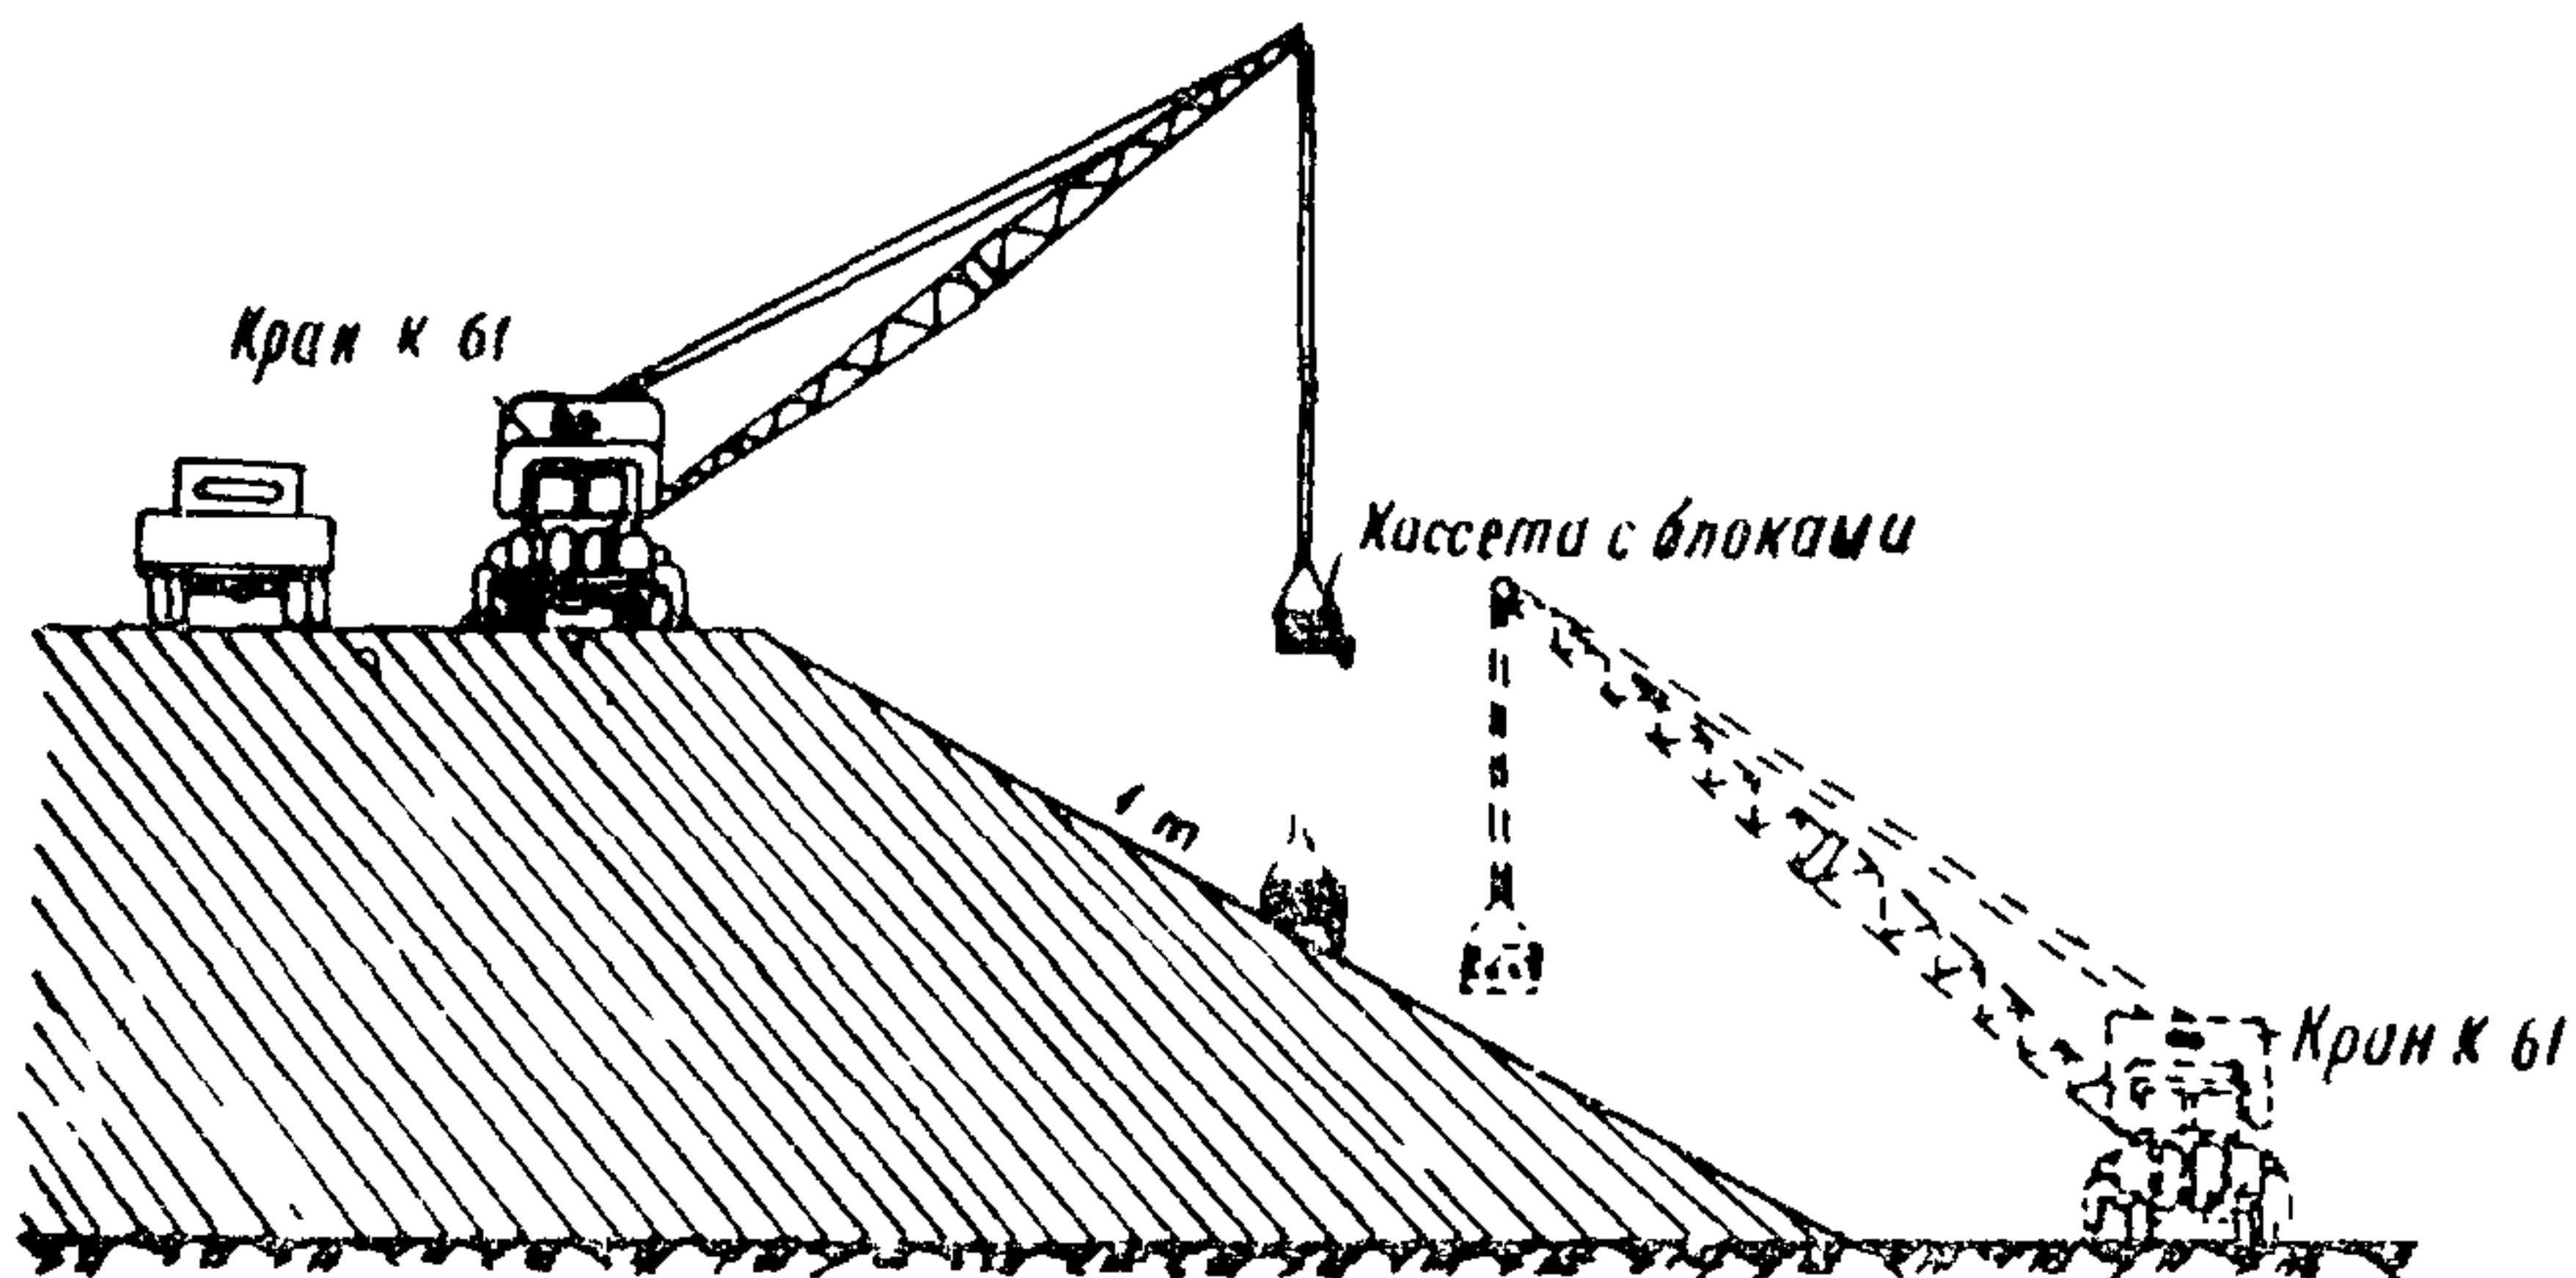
Схема укладки сборных элементов на поверхность откосов краном К-61
